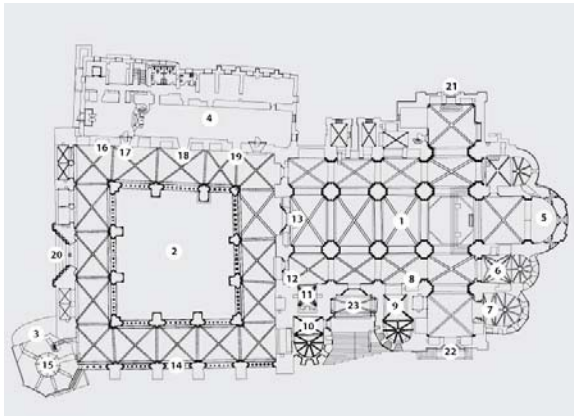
Lleida, Kathedrale und Klausur, Grundriss
